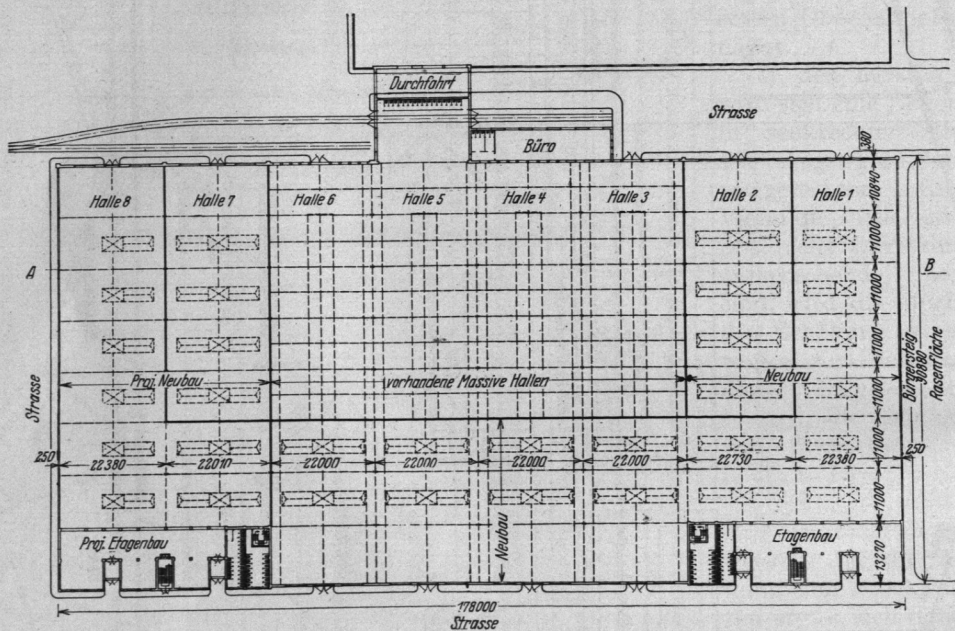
Grundriß eines über alten Holzhallen errichteten Hallenblockes mit Stockwerkskopfbauten.
